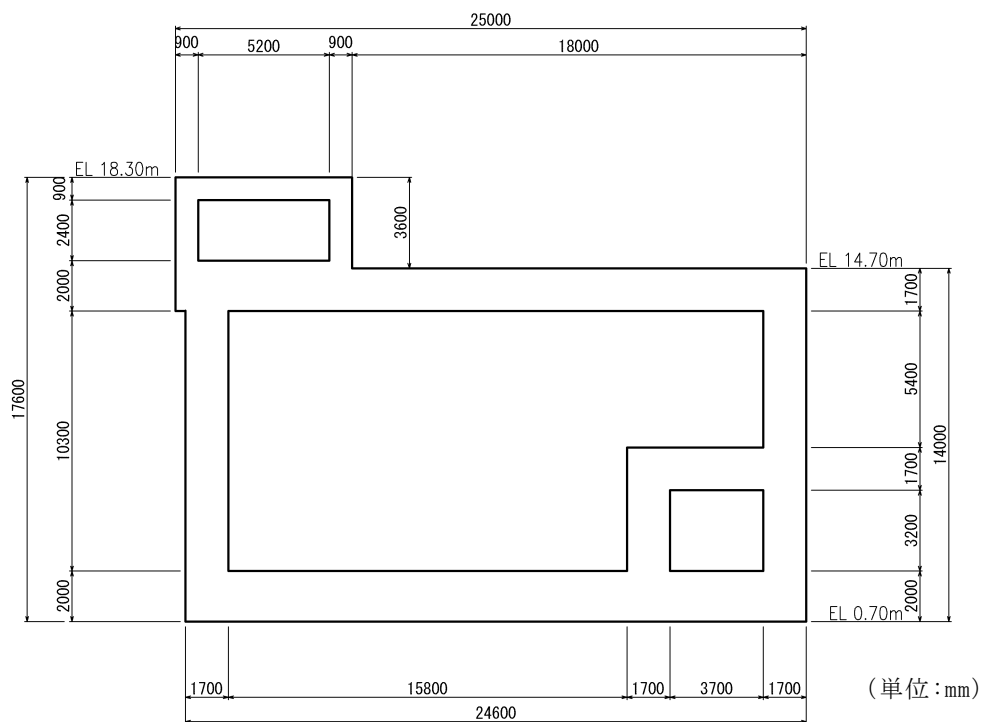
第 1 ベントフィルタ格納槽 断面図 (C-C 断面)
